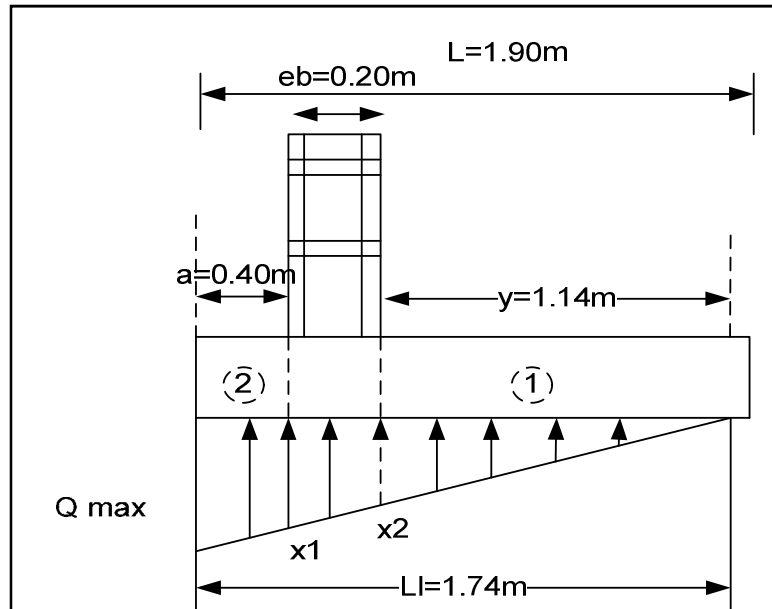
Placa cimentación muro retención mampostería reforzada 2 m
